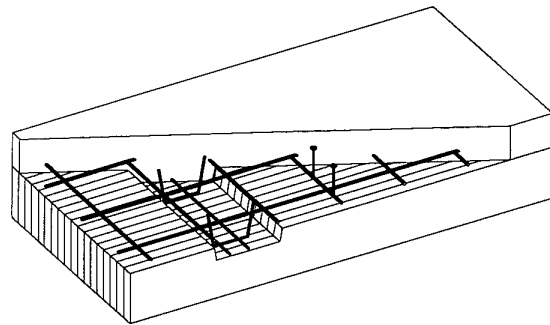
Schnittzeichnung einer HBV-Decke mit Querkerven
